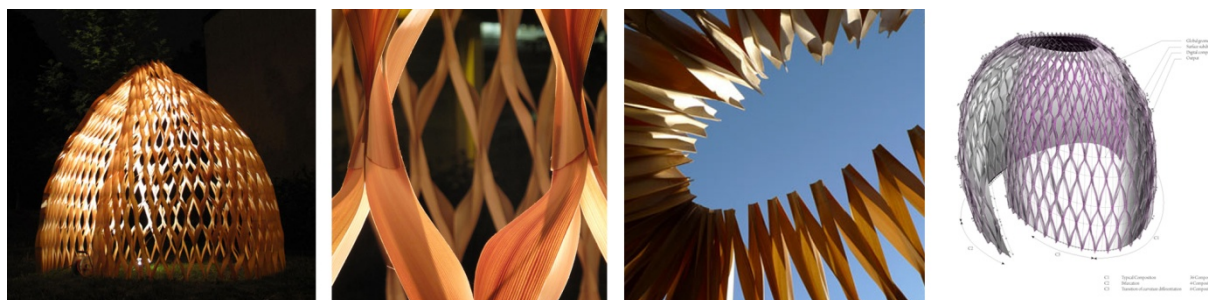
Stuttgartský pavilon – exteriér, postup konstrukce a schéma
